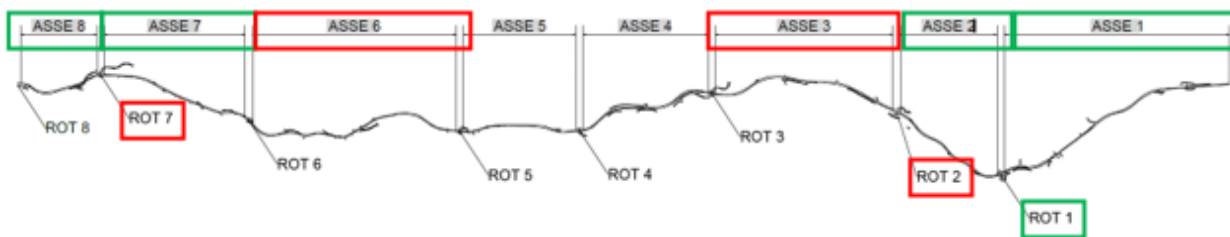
FASE 3 DI CANTIERIZZAZIONE
